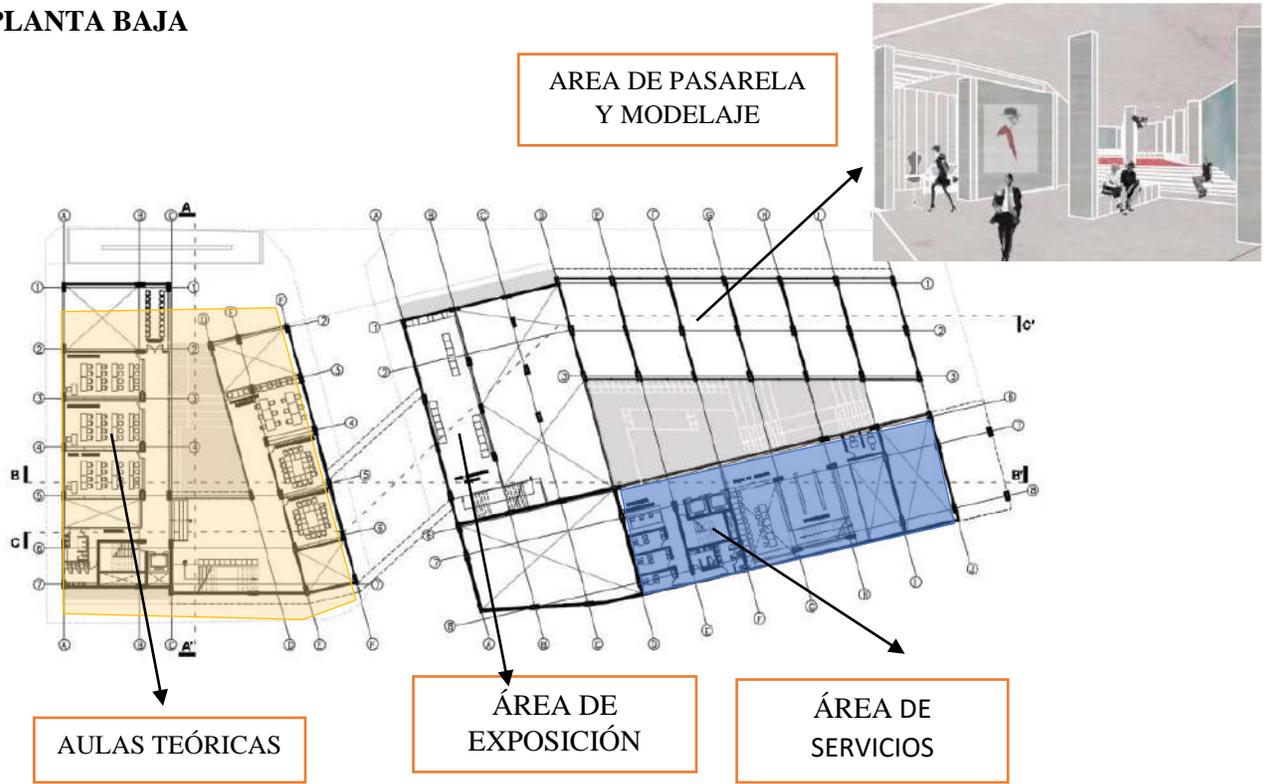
Análisis espacial de la UDTA – Ecuador. PLANTA BAJA.
